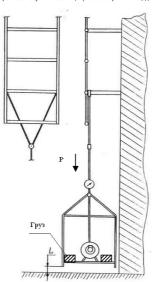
Испытание напрочность балки крепления вертикальной лестницы (высота отрыва площадки отземли L=100-200 мм)
